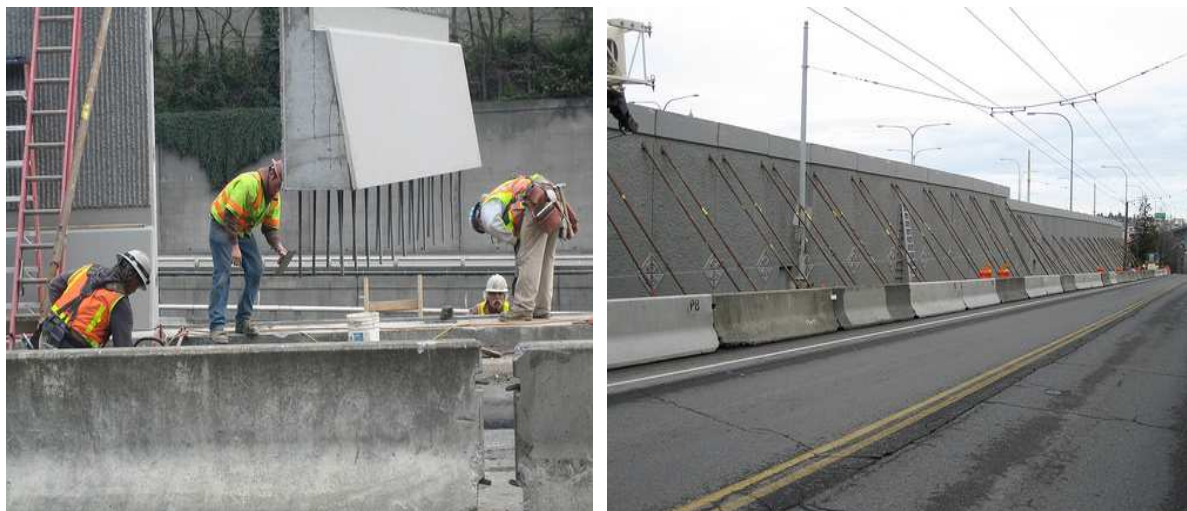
Instalação dos Painéis de Betão Armado sobre a Fundação
